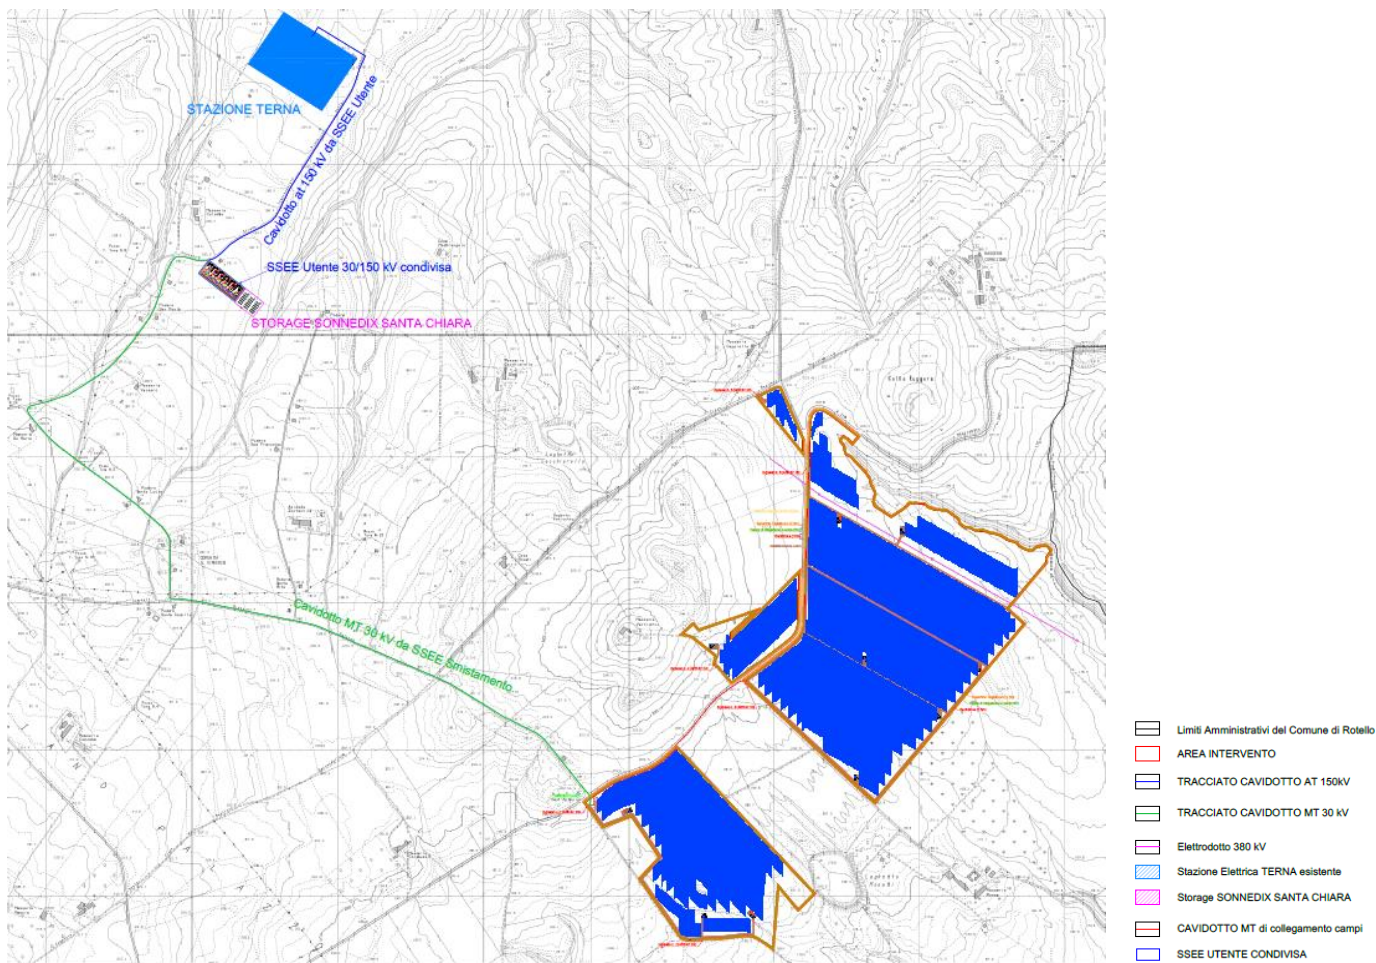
Layout dell'impianto su CTR. Elaborato di progetto EI.022 a cura della Società SONNEDIX SANTA CHIARA S.r.l
